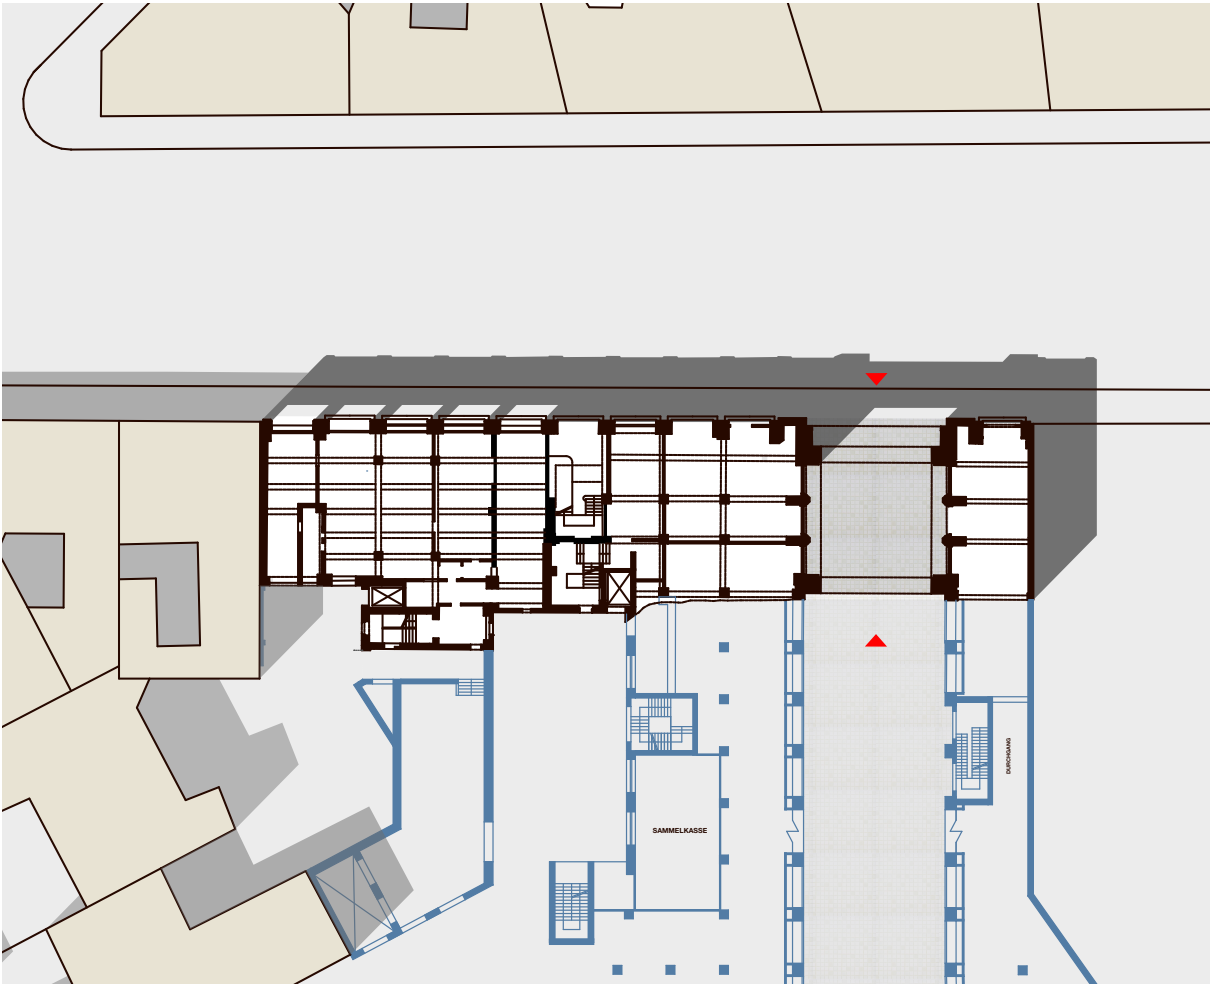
„Kunsthau Tacheles“; Grundriss Erdgeschoss, Stand 1990 (maßstabslos)
